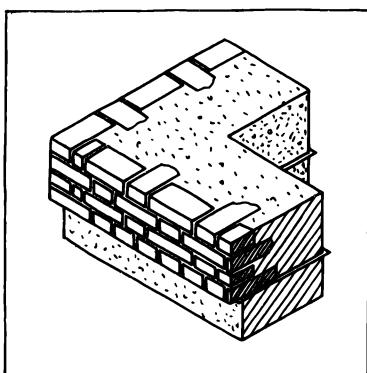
Стена из монолитного шлакобетона с кирпичной облицовкой
